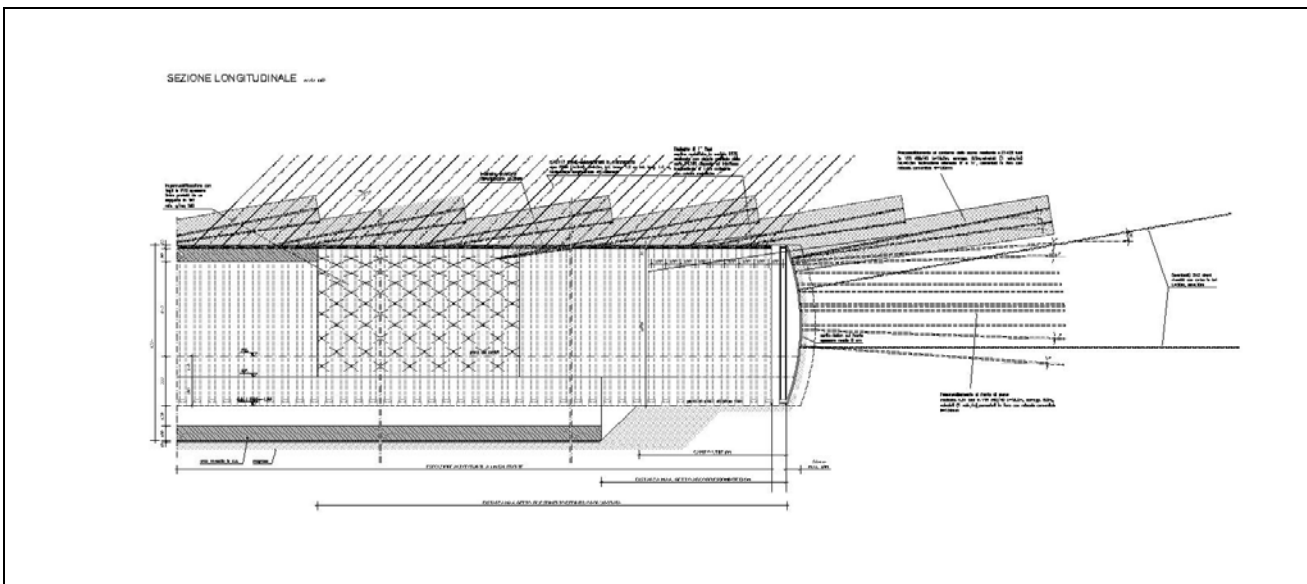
Sezione di scavo tipo GD-B2 - Sezione longitudinale
